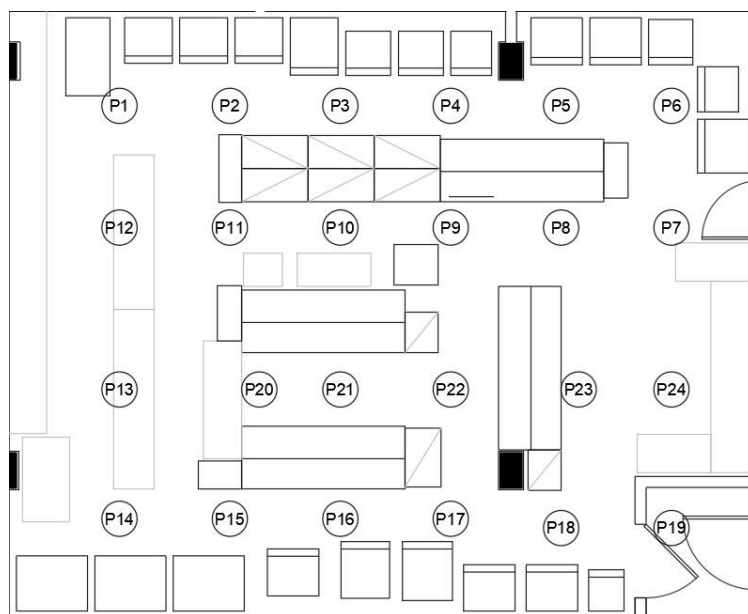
Planta esquemática dos pontos de medição da sala 525, Pav. Rocha Lima. Sem escala.
